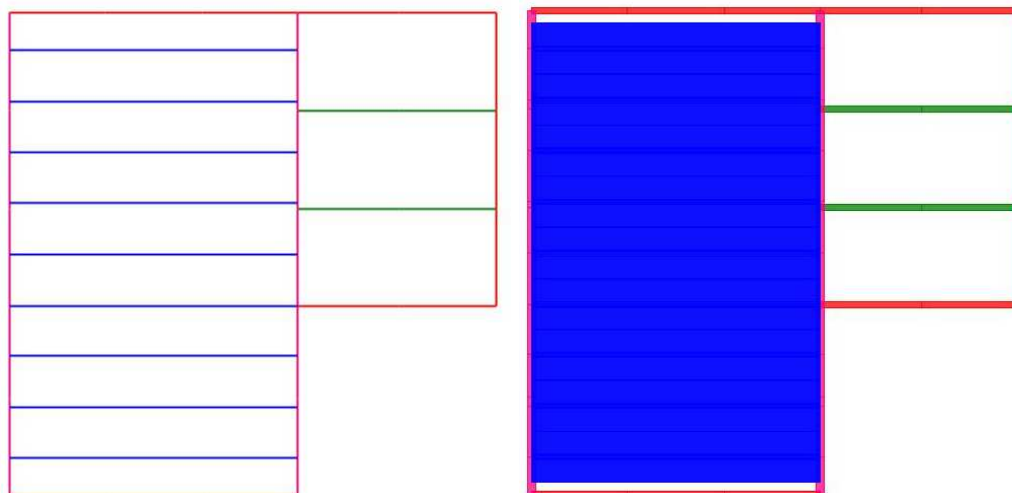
Orditura delle travi prefabbricate di copertura del Lotto C (a sinistra gli elementi linea frames e a destra la loro estrusione rispetto alla sezione).
